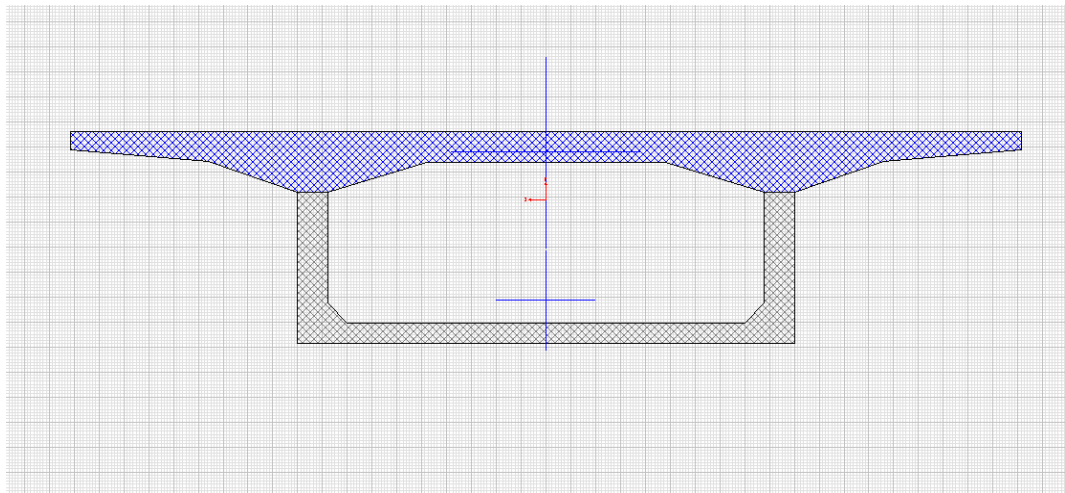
Dimensiones y propiedades de la viga cajón dovela 5A puente Bermúdez.
